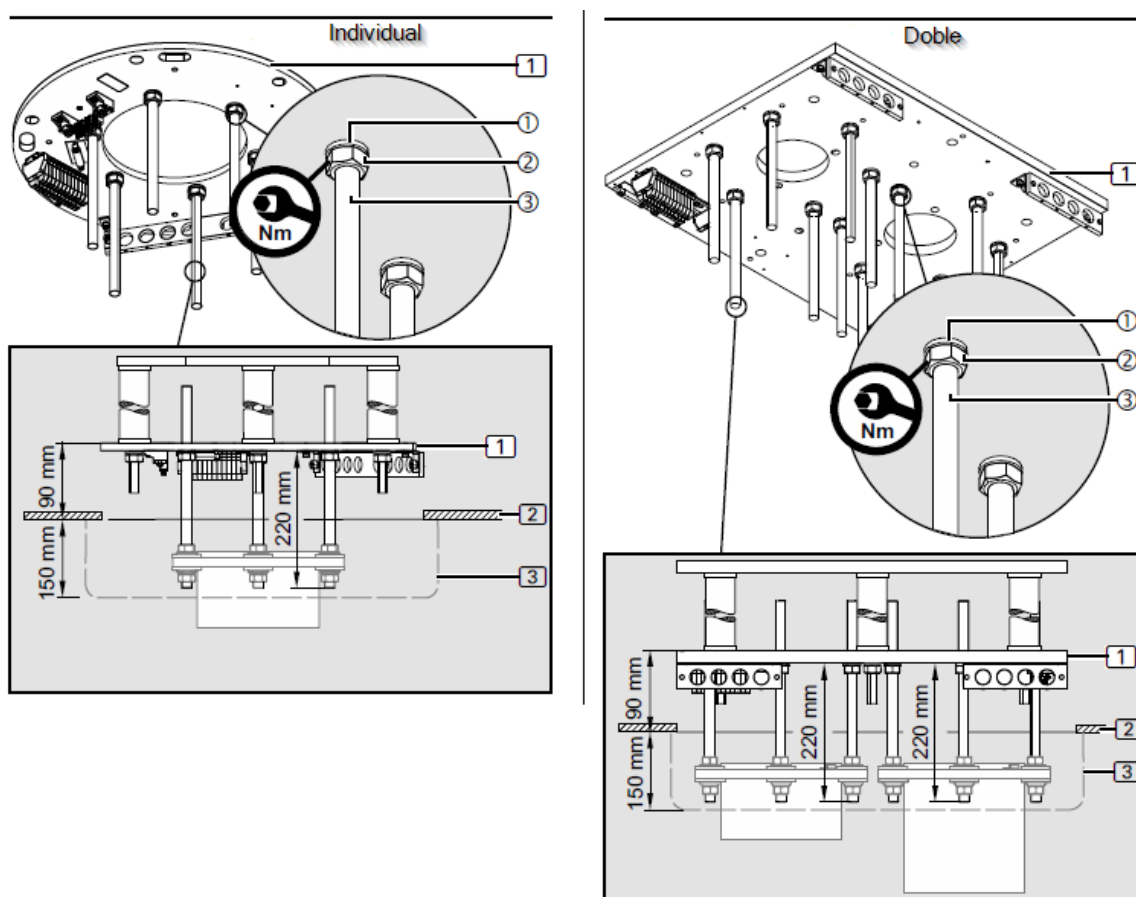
Montage de la plaque d'interface avec le faux plafond
